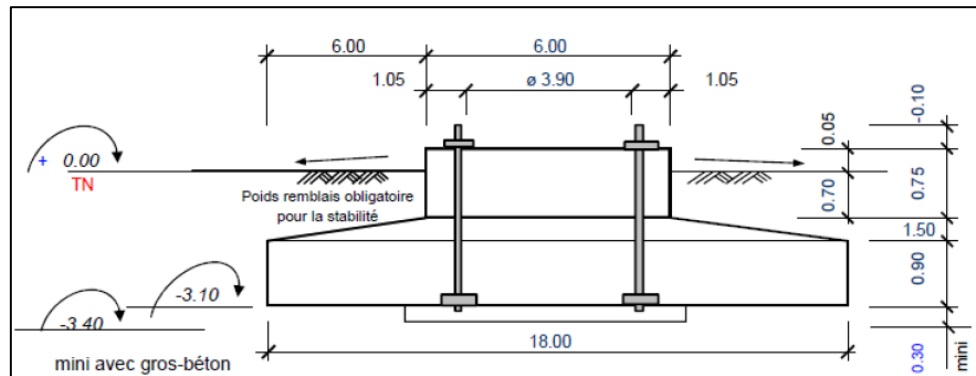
Fondation type V117-3.3 MW (Source : Vestas)
